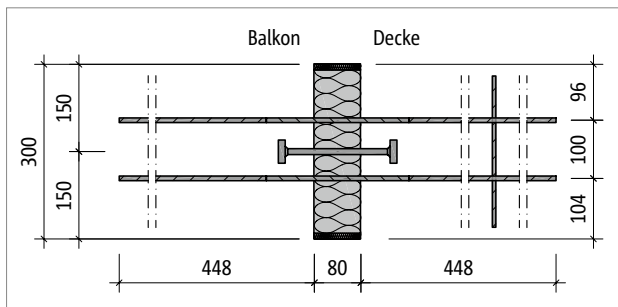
Schöck Isokorb® T Typ QP-V1: Produktgrundriss
